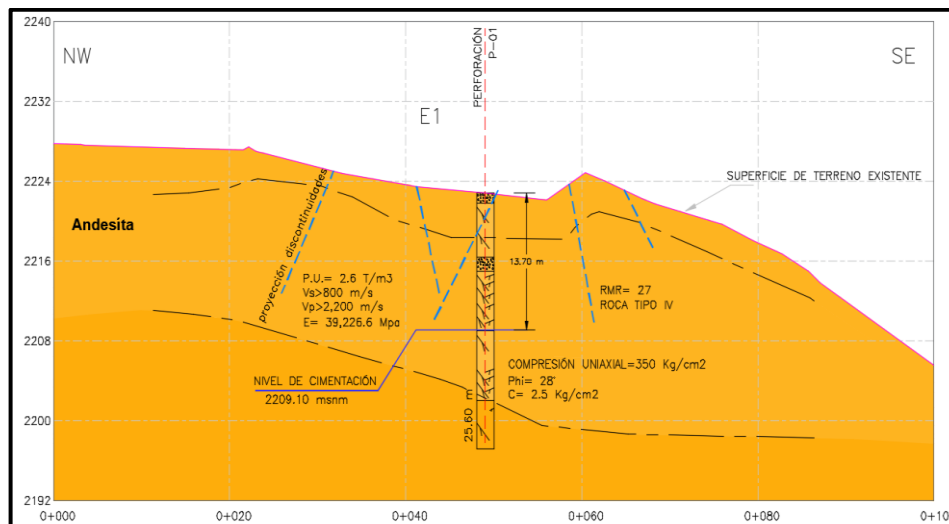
Perfil longitudinal de la zona de cimentación superficial – Estribo E1.
